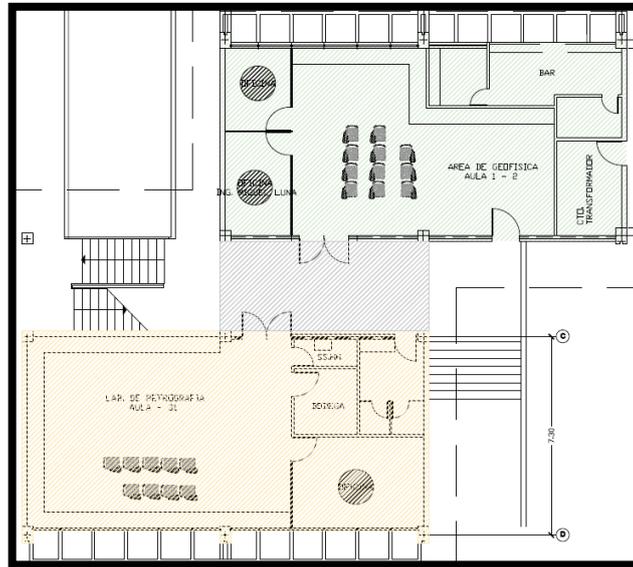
Extintores, planta baja, Edificio 20-A, Zona 1
